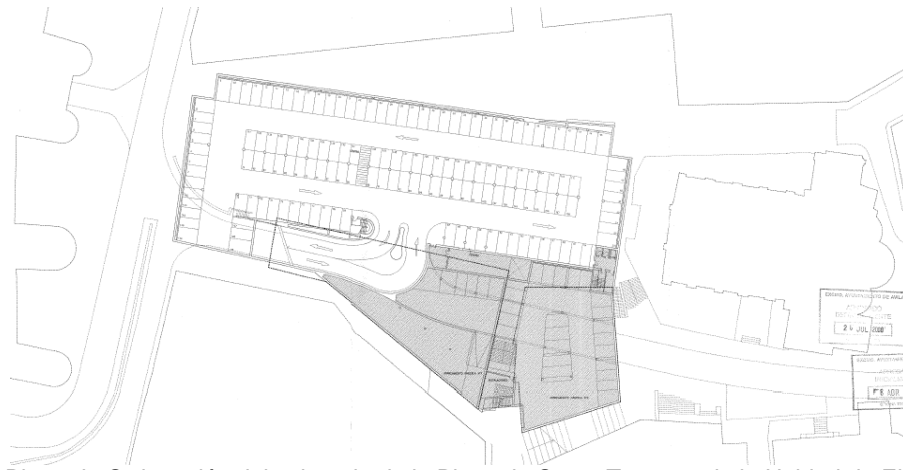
Plano de Ordenación del subsuelo de la Plaza de Santa Teresa y de la Unidad de Ejecución 76/1. Plan Especial de Reforma Interior Mercado Grande de Ávila (2000).
